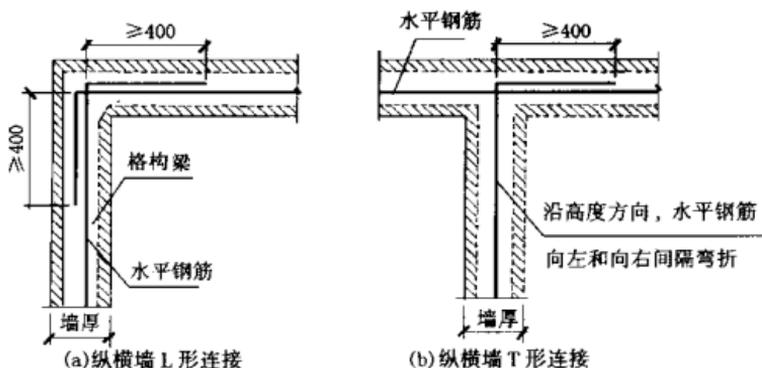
房屋墙体连接处芯孔内水平钢筋的连接
